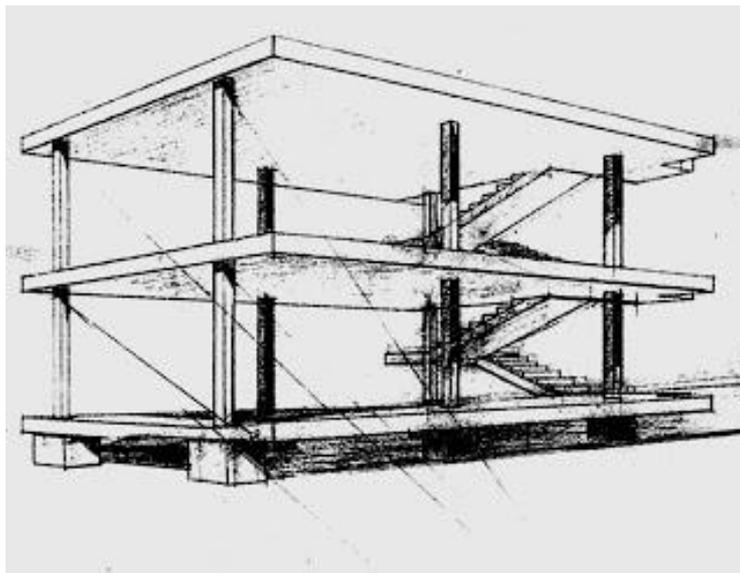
Esquema Domino, (da autoria do arquiteto Le Corbusier). O esquema - constituído por lajes planas, pilares e fundações em betão armado - sintetiza os princípios construtivos da Arquitetura Moderna. Fonte: <<http://arqui-contemporanea2.blogspot.gr>>.
